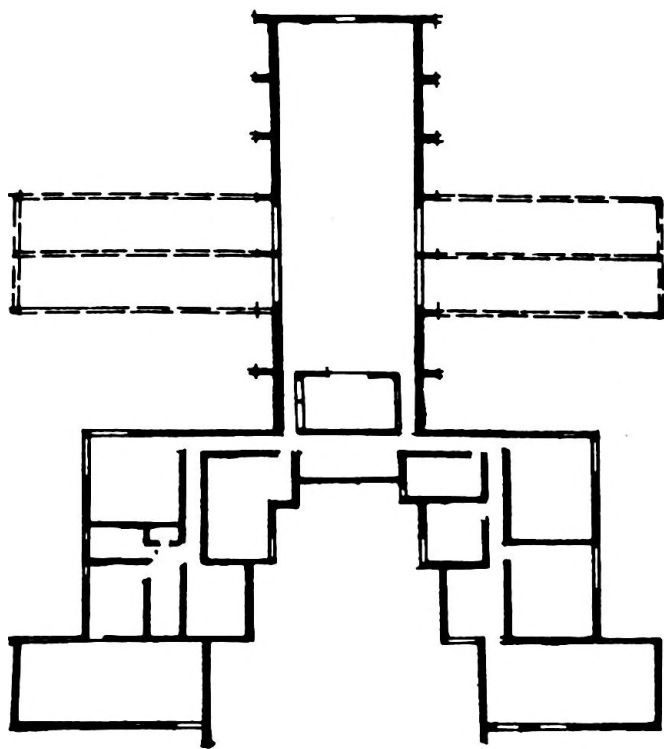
Planta da Casa da fazenda Capuava, antes da reforma de 1942
